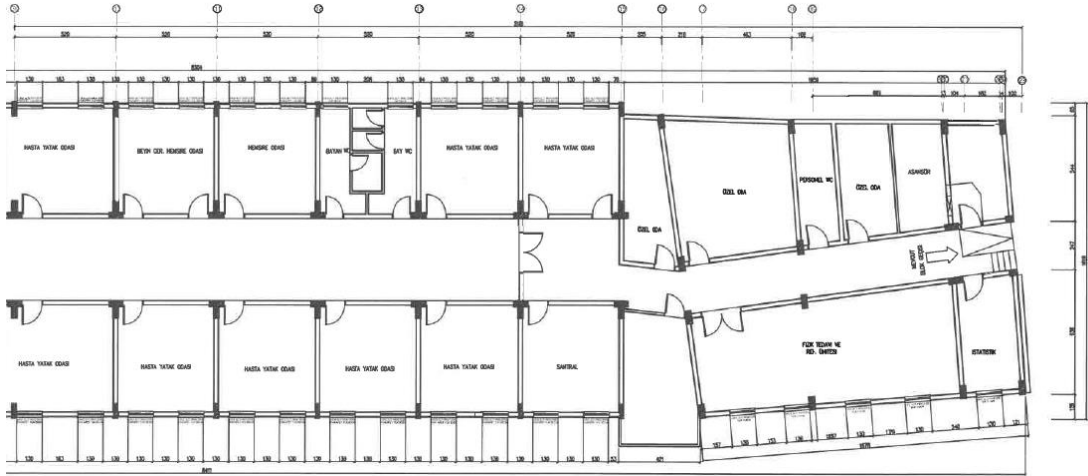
A blok 1. kısım 1. kat kat planı.
